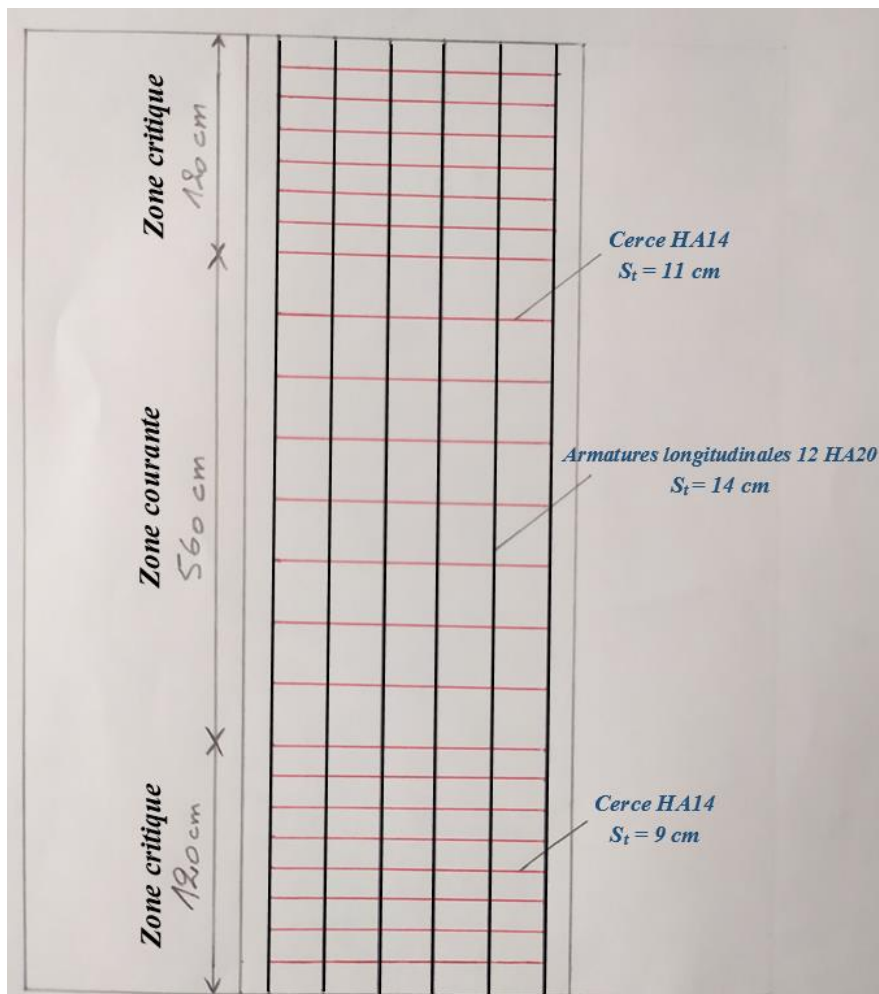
Coupe longitudinale du ferrailage du pieu.
